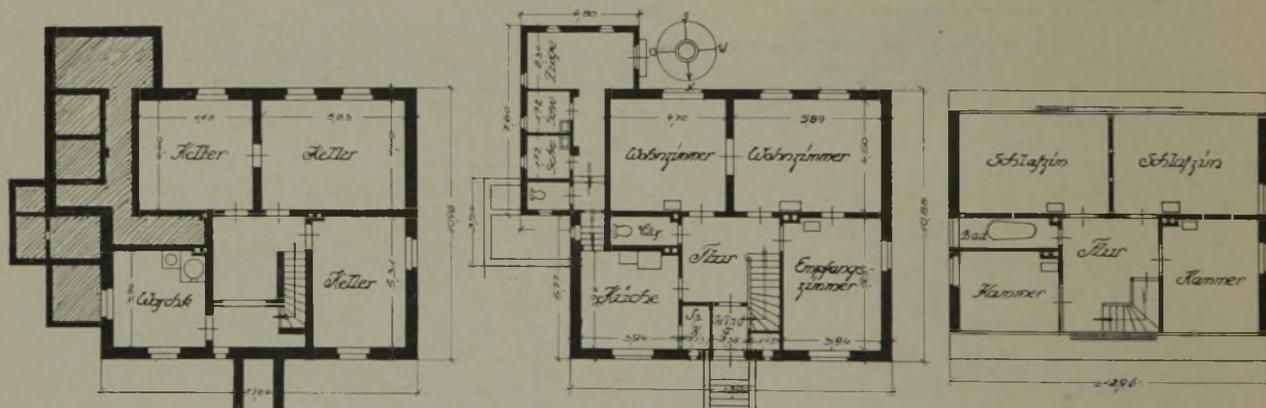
f. Kellergeschoß, Erdgeschoß und Dachgeschoß. (1 : 300.) Landhaus Archidir. Dr. V o g e s, Wolfenbüttel.
